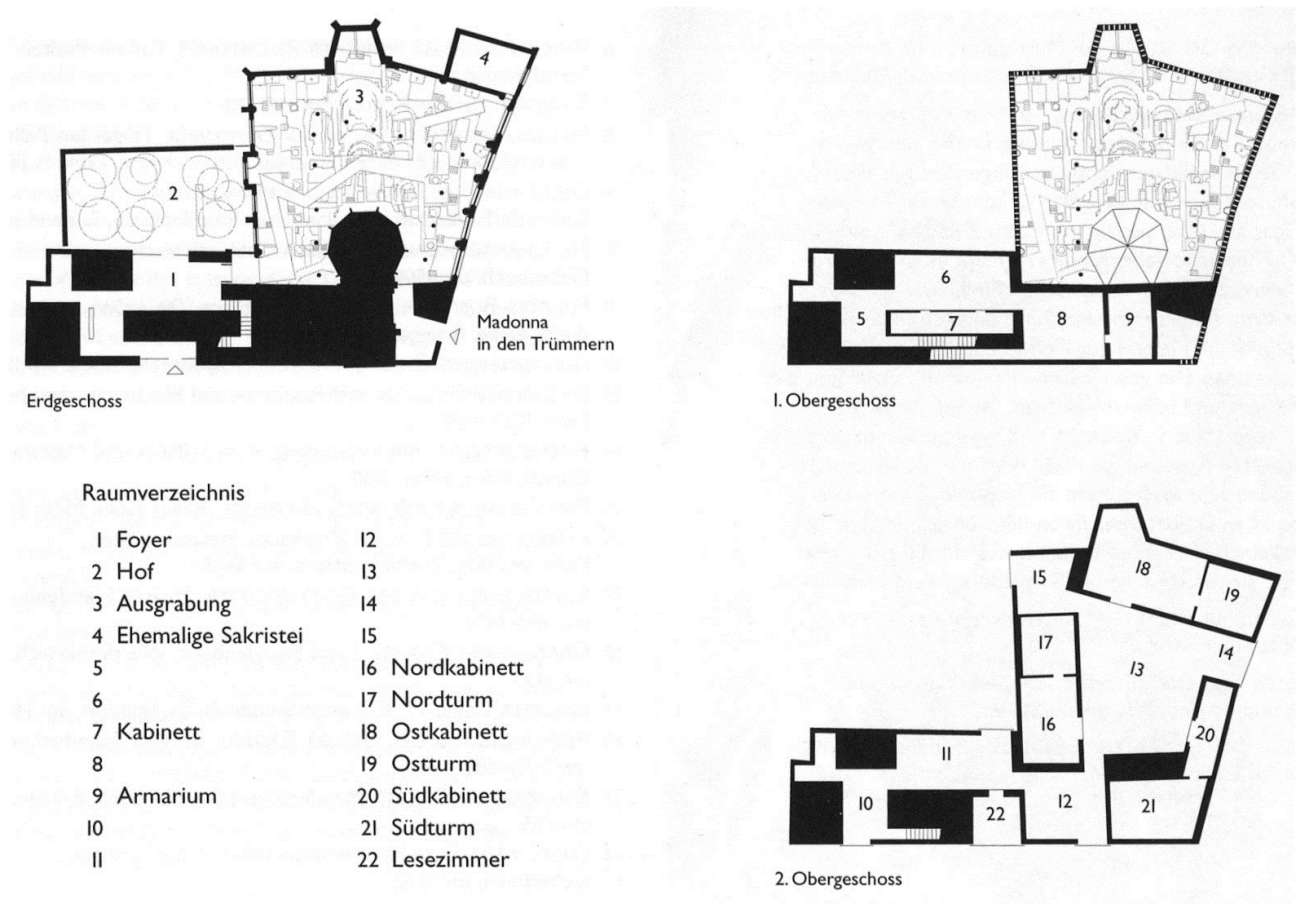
Grundrisse des Erdgeschosses, des 1. und 2. Obergeschosses.
